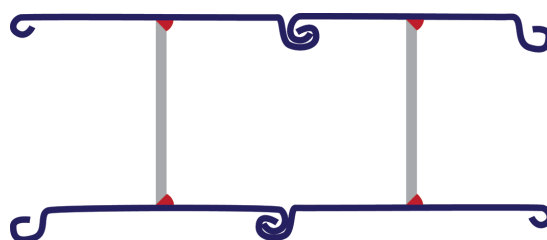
Несущая свая с Н-образным сварным сечением и двойной х/к ПФЗ
